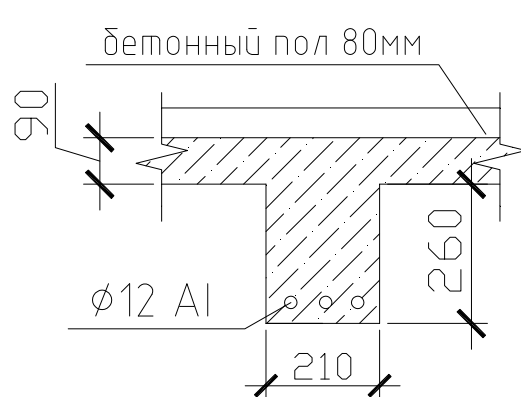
Второстепенная балка ж/б перекрытия фойе над вторым этажом в осях «1-7/А-Г»
